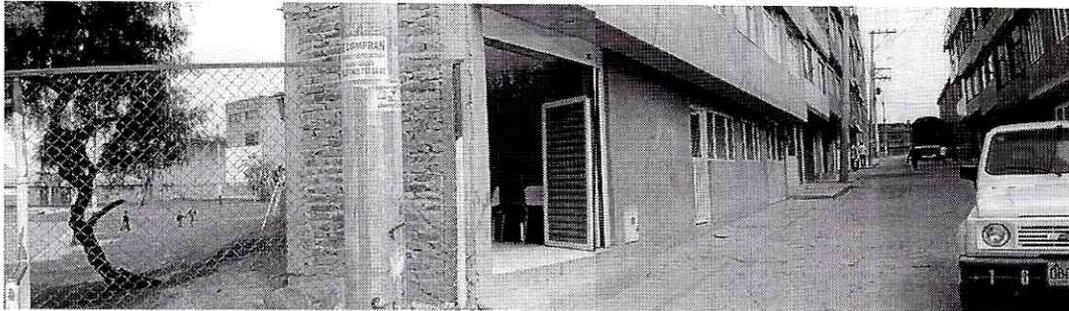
Las viviendas son de dos, tres y más pisos construidas en material definitivo (mampostería), no hay predios sin construir
